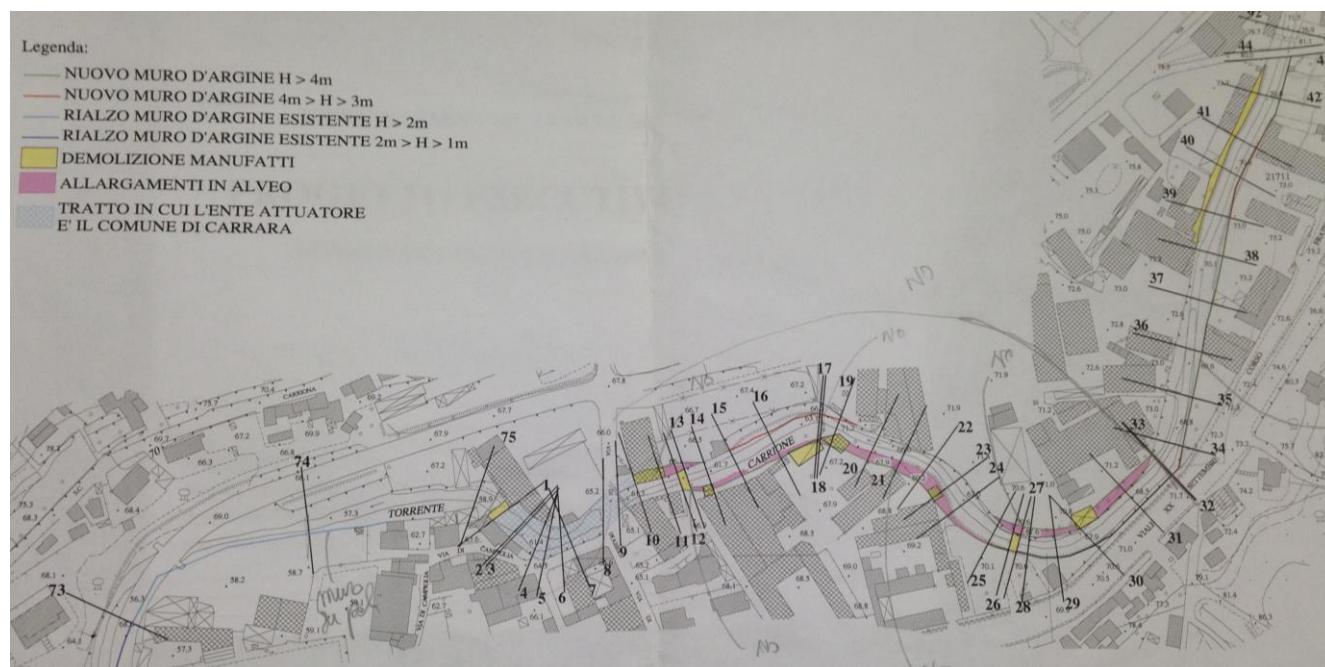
Estratto Pratica Sismica N. 802/2013 – Planimetria interventi
